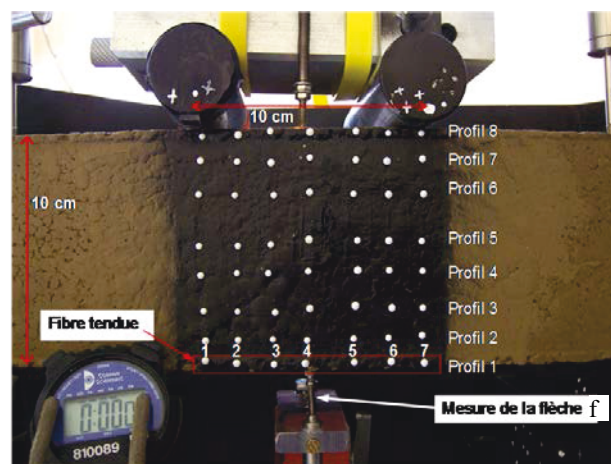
Zone centrale de la poutre en flexion avec le maillage pour suivi photographique (Camp-Devernay, 2008)
